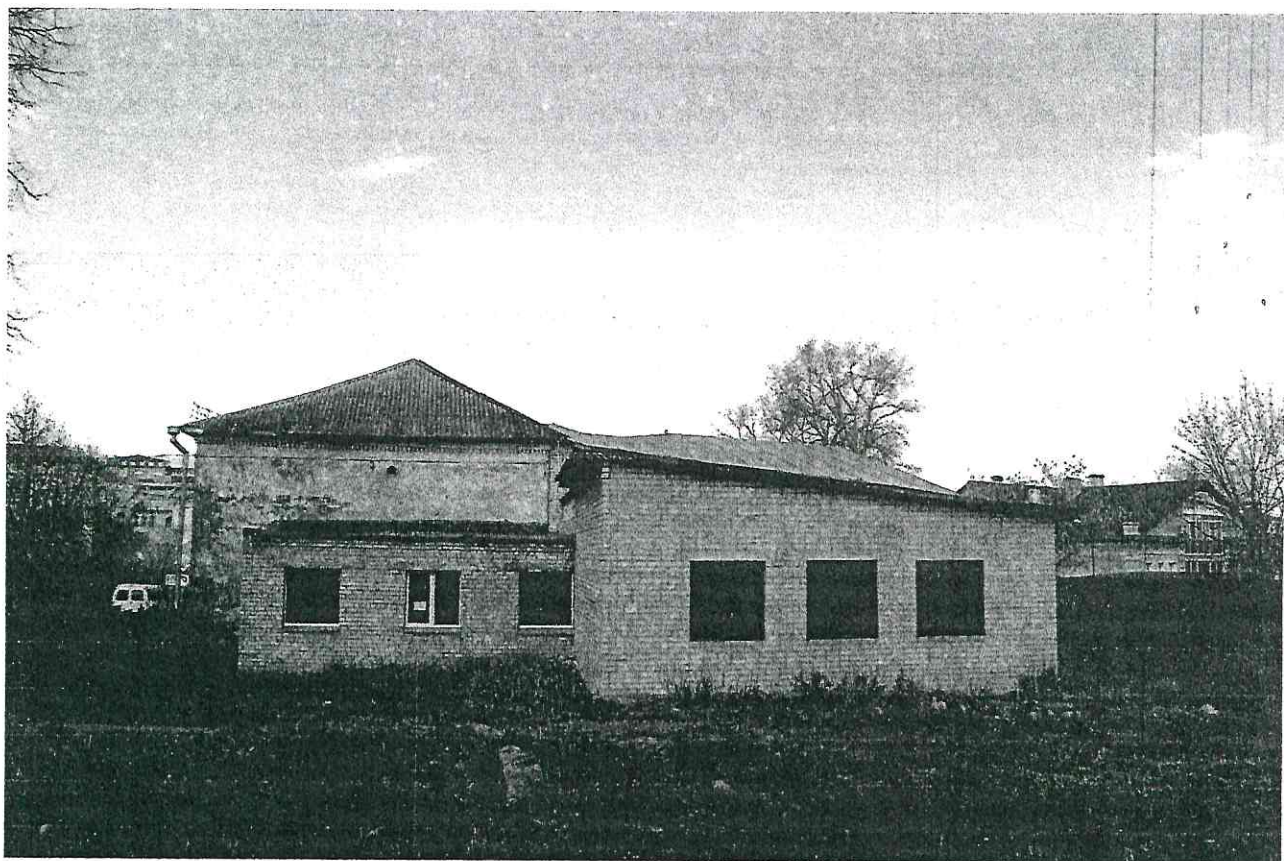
Общий вид объекта культурного наследия с юга. Повреждение системы водоотведения с кровли; повреждение покрытия кровли; повреждение отделочных покрытий фасадов; замокание кирпичной кладки цоколя; повреждение оконных заполнений; повреждения отмостки; поздние каменные пристрой. Фото 18.04.2023.
